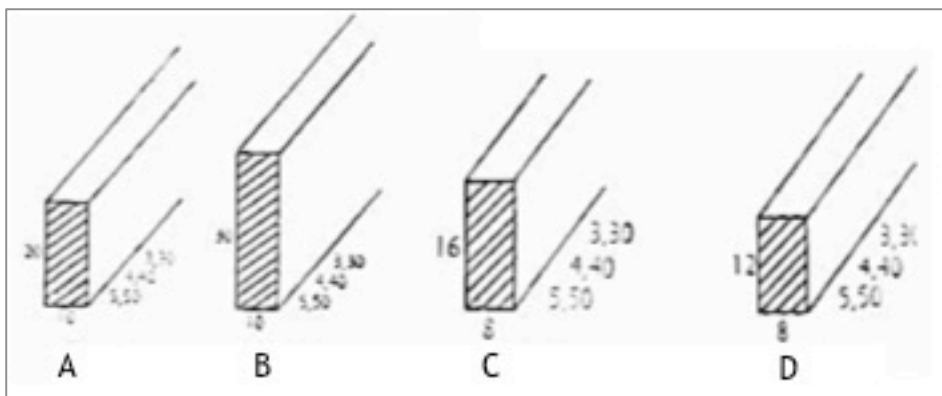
A, B - Barrotes ; C - Tirantes ; D - Tirantinhos. Fonte: PIANCA (1980)
